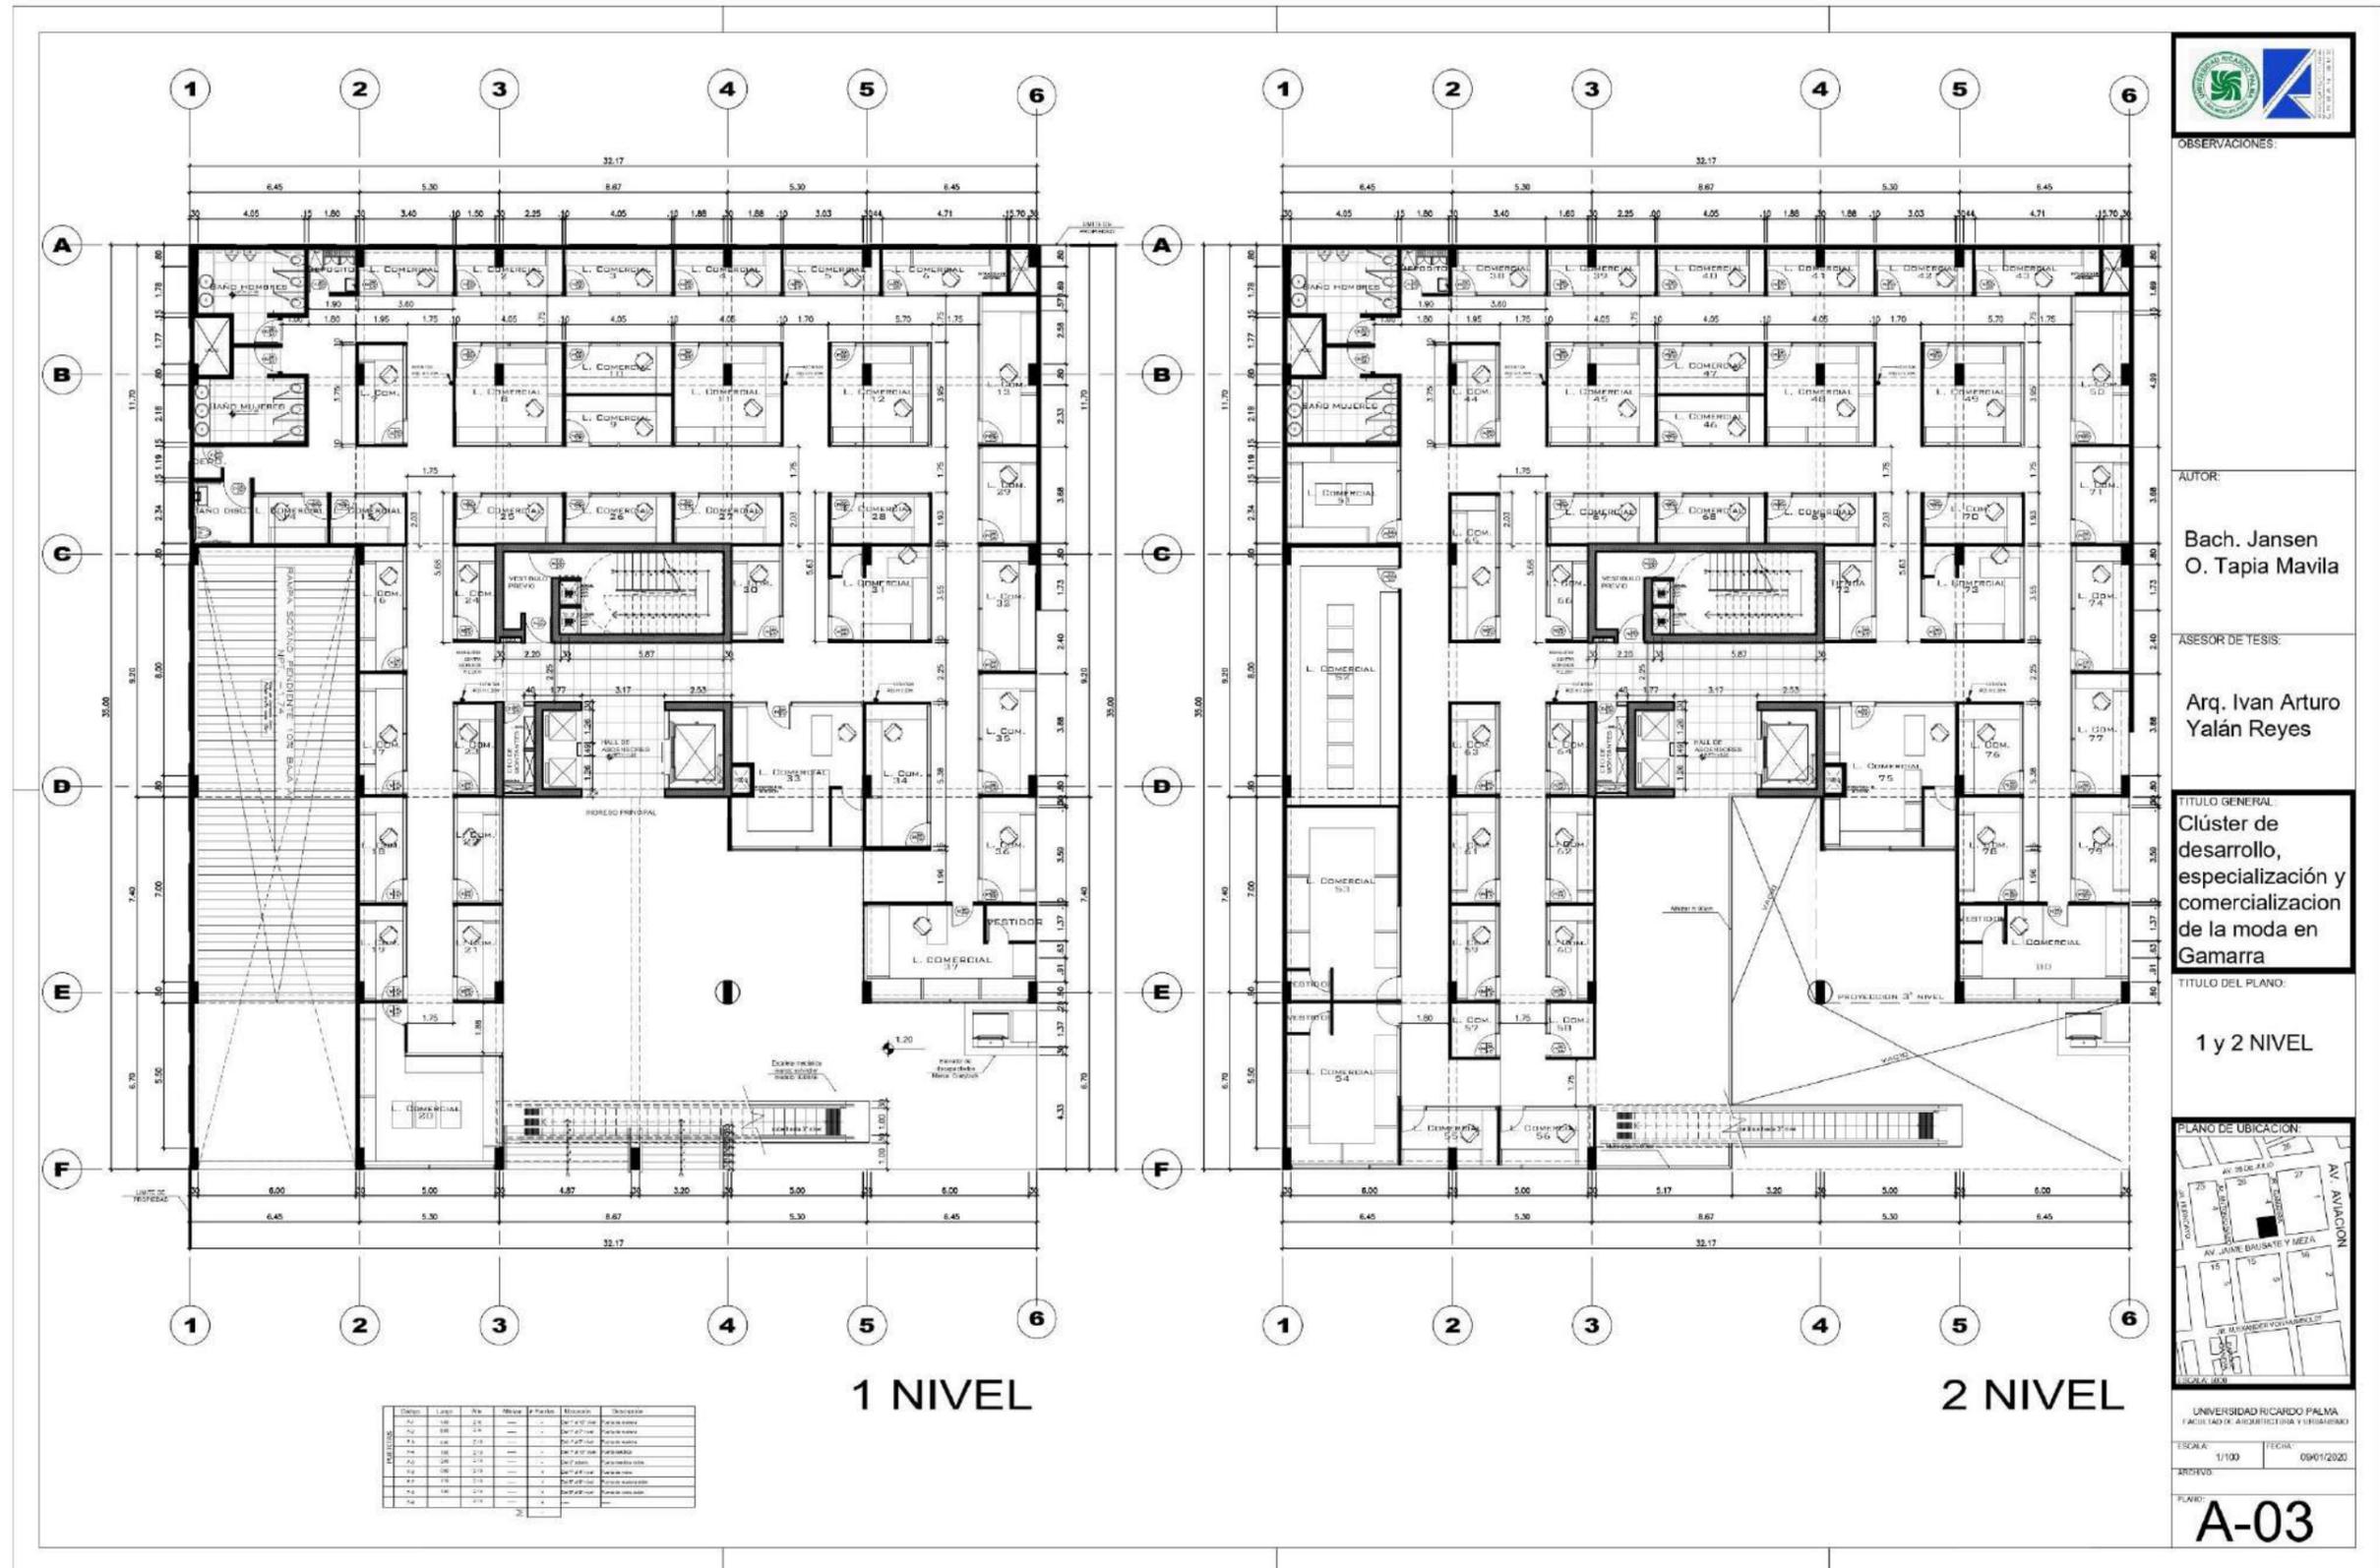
Planimetría de Nivel 1 y Nivel 2 (Fuente: Elaboración Propia)
